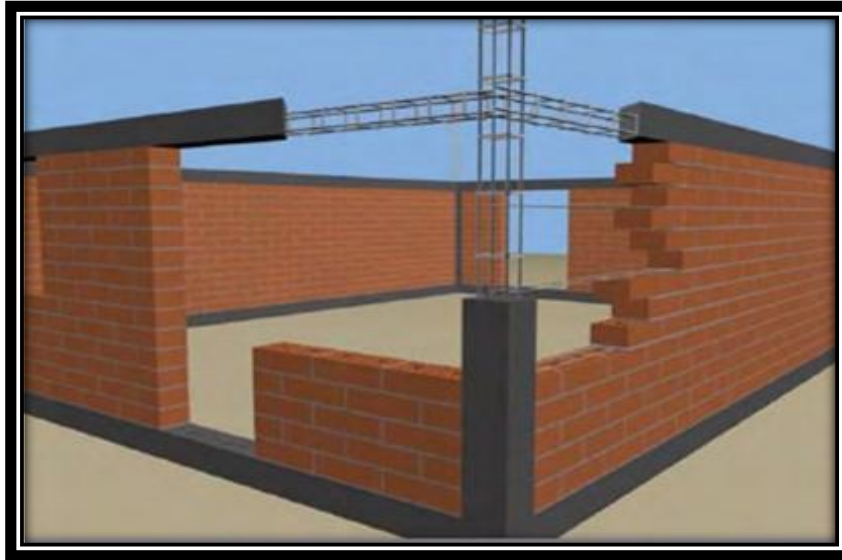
ALBAÑILERÍA CONFINADA
